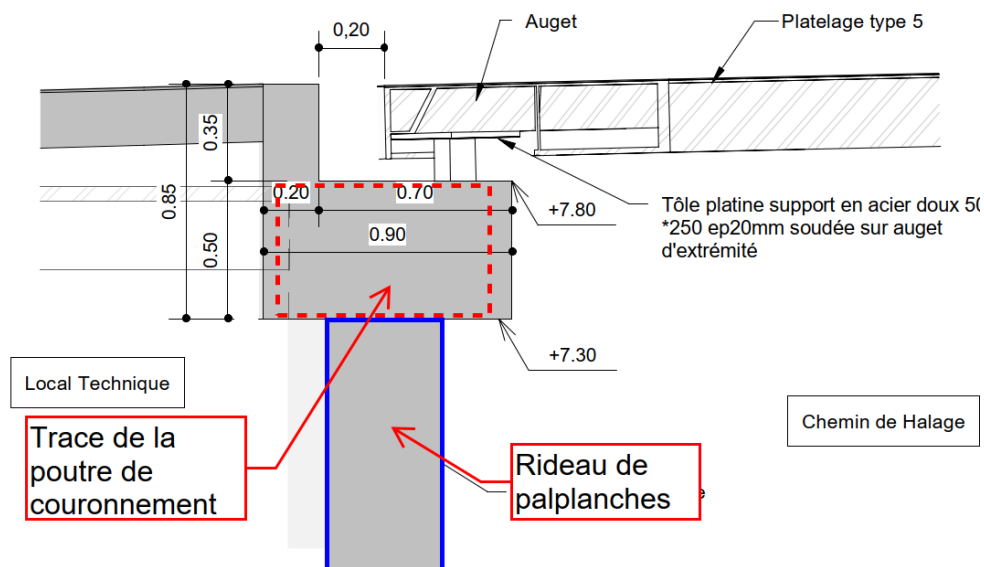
Rive gauche, appui du platelage et de la dalle de pontage sur une poutre-appui en remplacement de la poutre de couronnement
